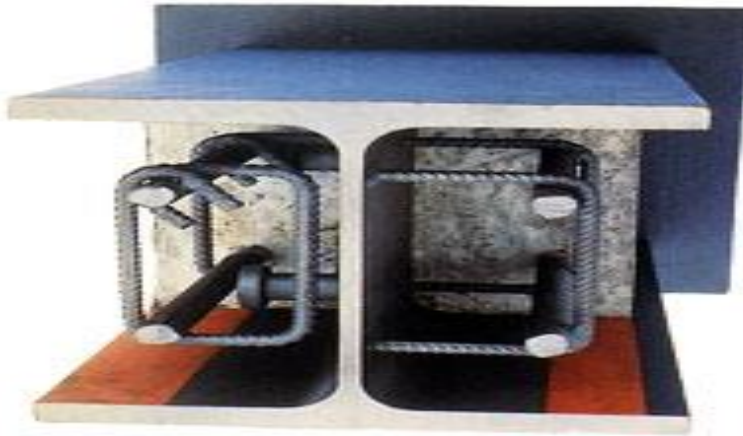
La présence des armatures dans la poutre mixte [5]
